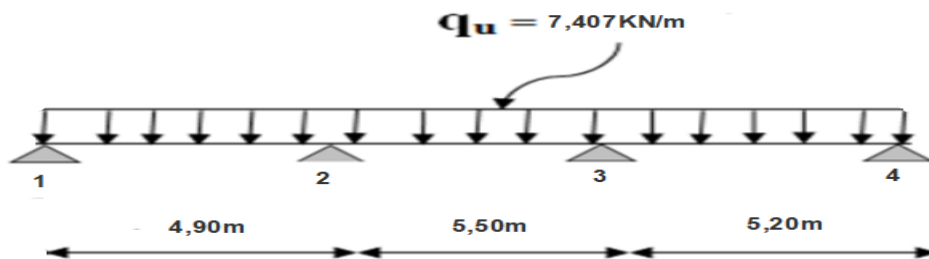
schéma statique de poutre continue reposant sur quatre appuis.
